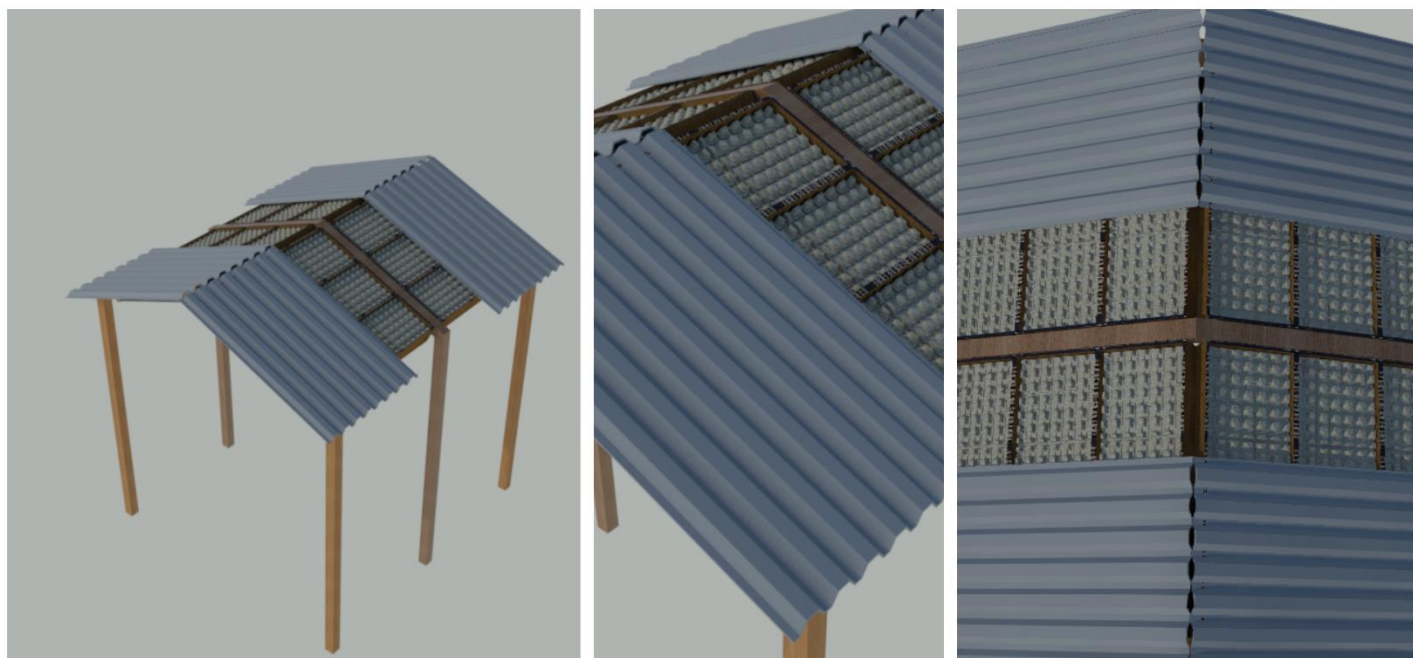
Caseta con aislamiento acústico. Elaboración propia.
